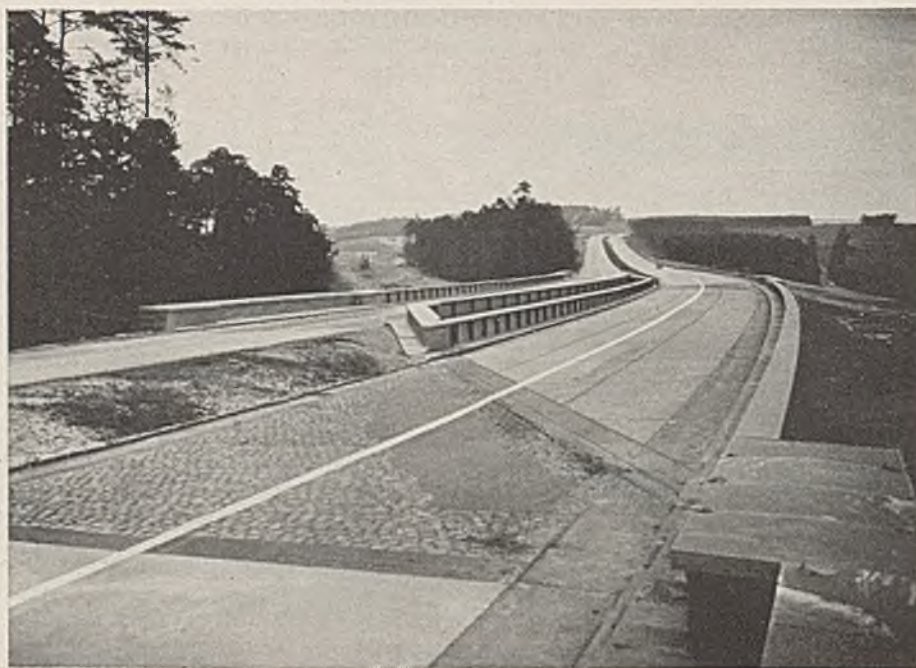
Blick auf das fertige Bauwerk nach Osten.
